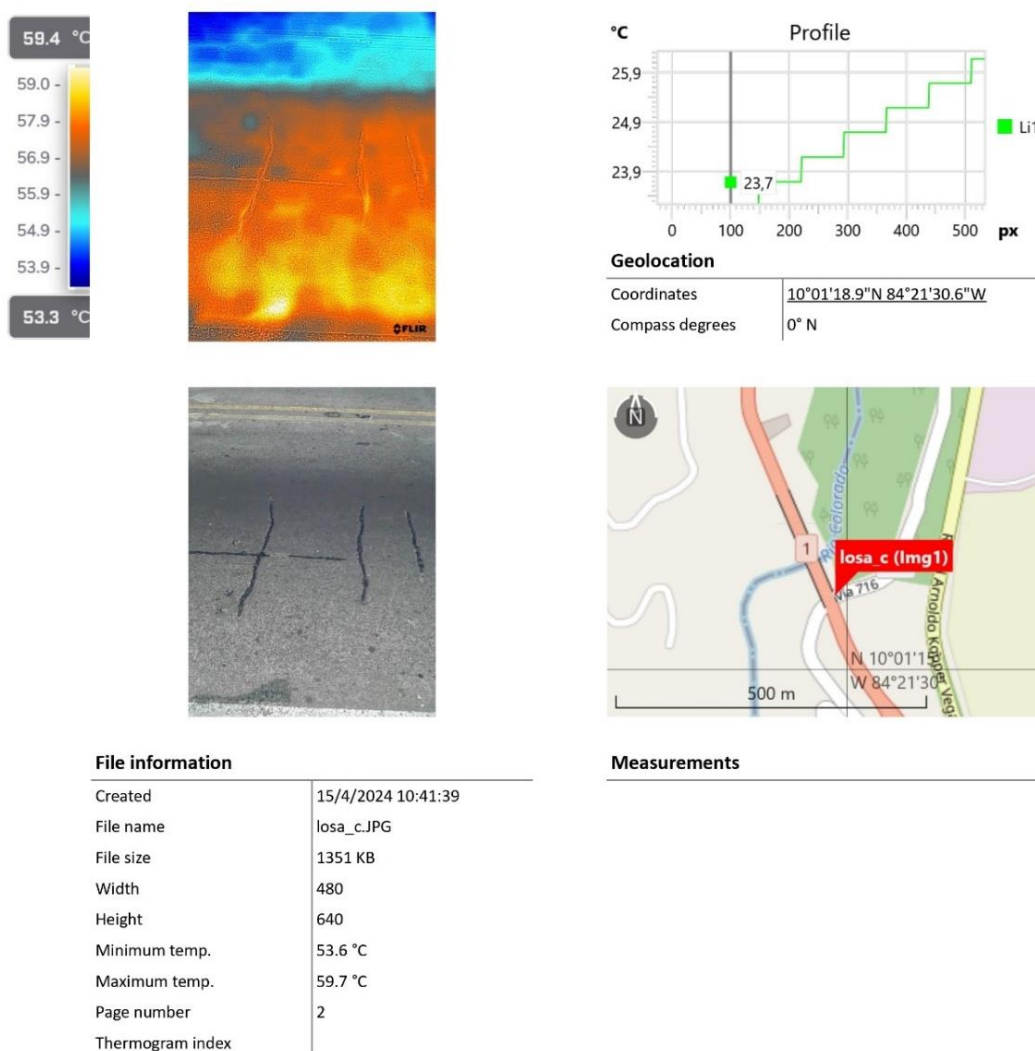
20 Reporte de grietas en dos direcciones en la losa de la sección No. 3
